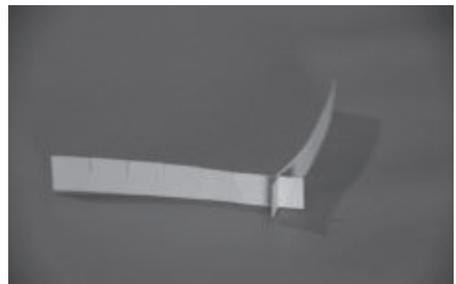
| Encaixe das demais vigas do pergolado em uma das vigas de base
